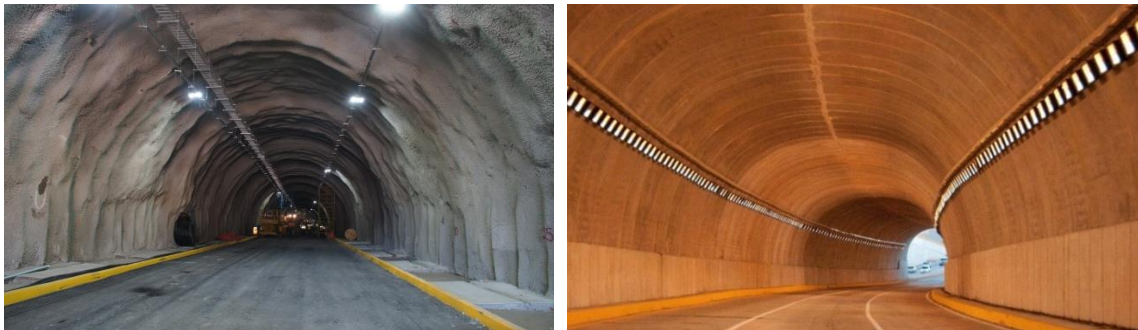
Comparativa de revestimientos de concreto lanzado e hidráulico.
